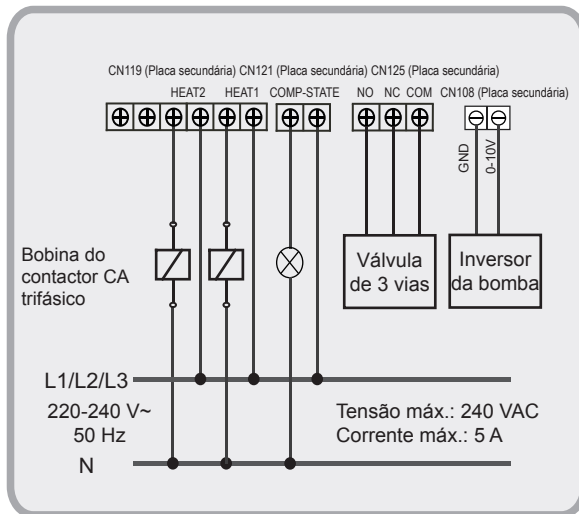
Cablagem do aquecedor auxiliar da tubagem e da luz ac do estado do compressor (65 kW e 110 kW)
